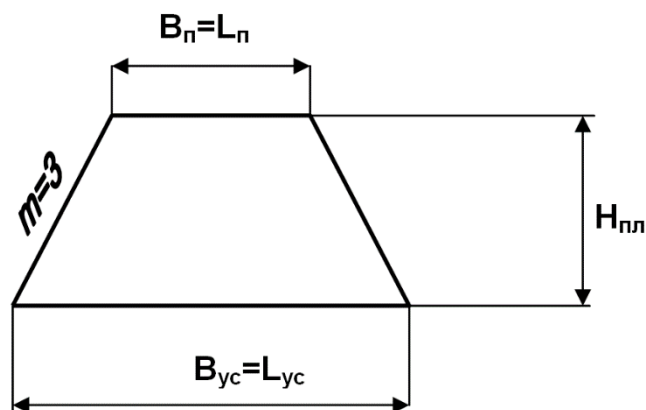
Поперечное сечение участка складирования (без котлована) – разрез А–А
